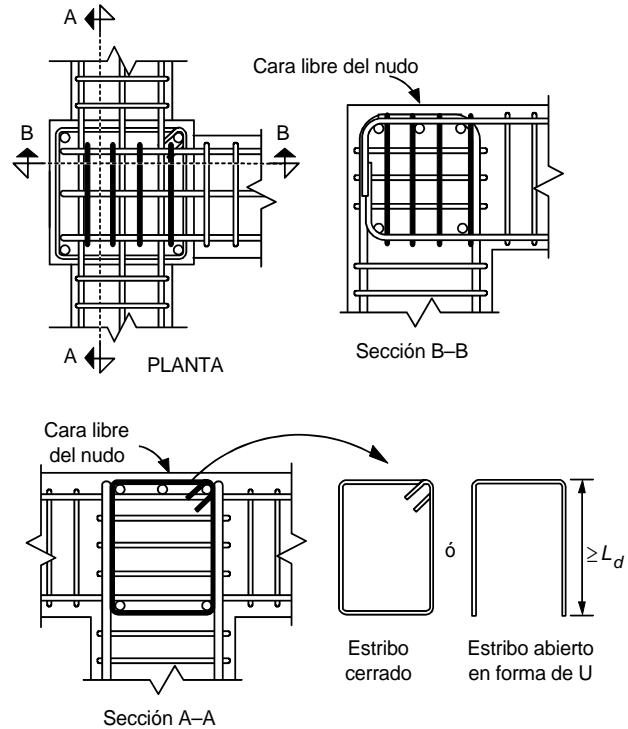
Refuerzo transversal vertical en uniones viga – columna
